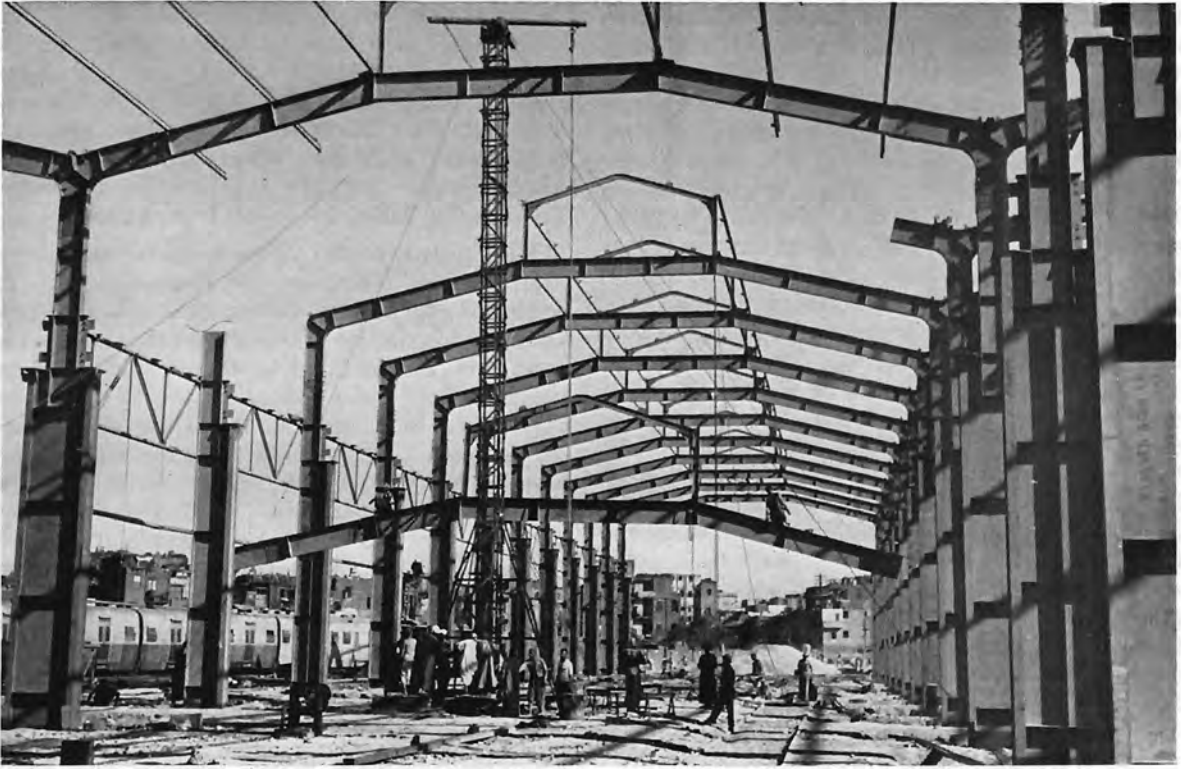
Bauzustand mit zum Teil montierten Dachriegeln
